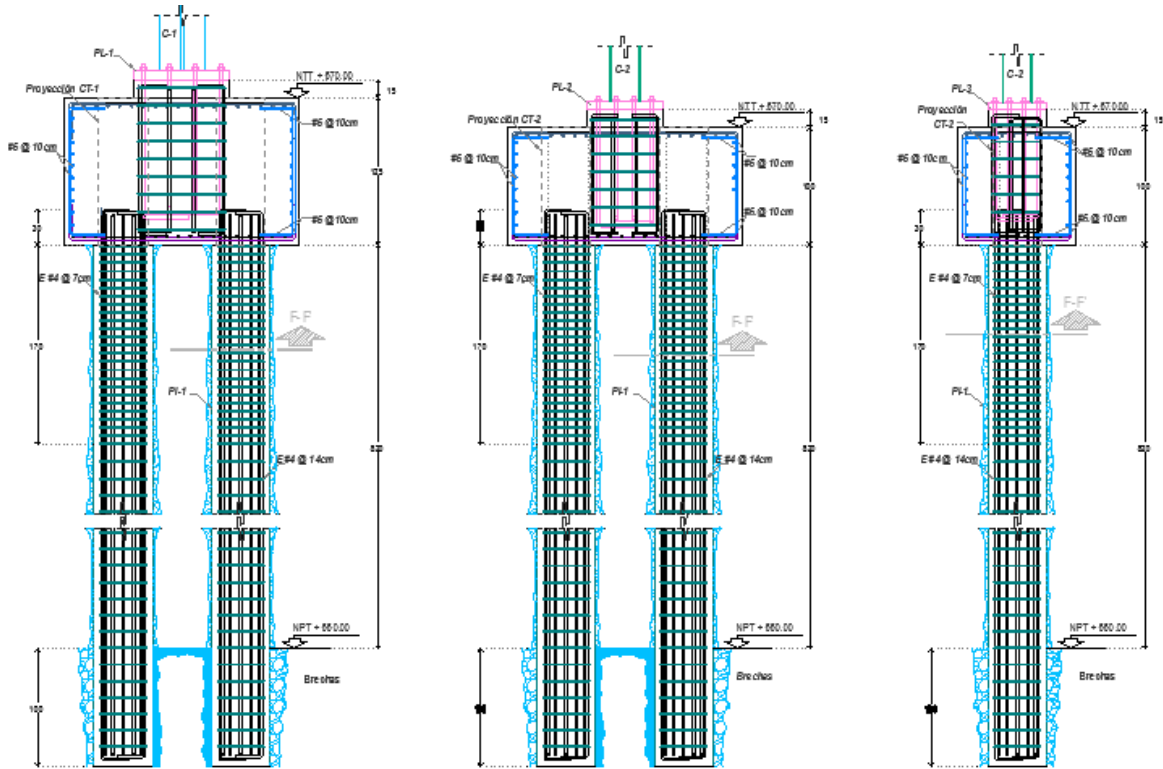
Arreglo de pilas y dados de cimentación para casa de máquinas (Vista lateral)
